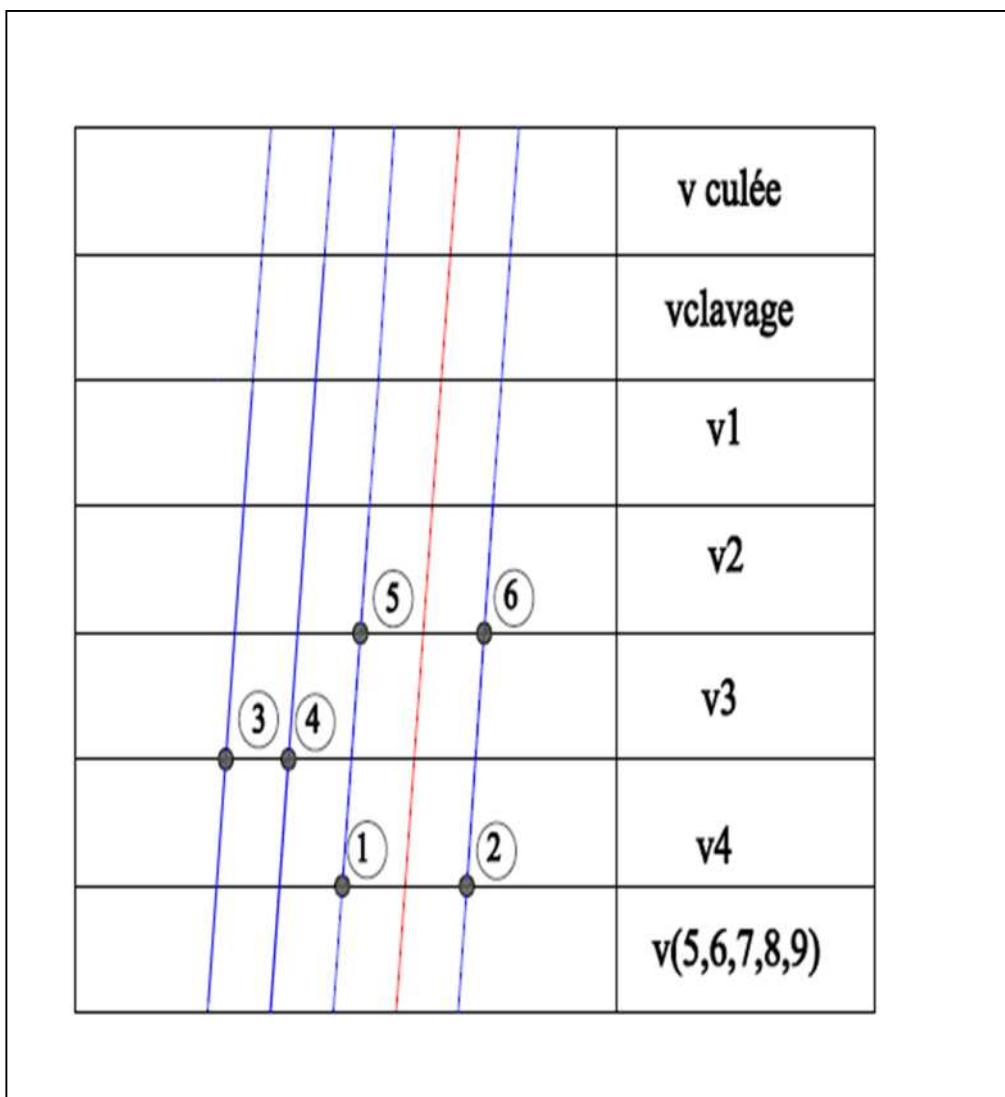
Disposition des câbles de continuité en plan (travée de rive).
